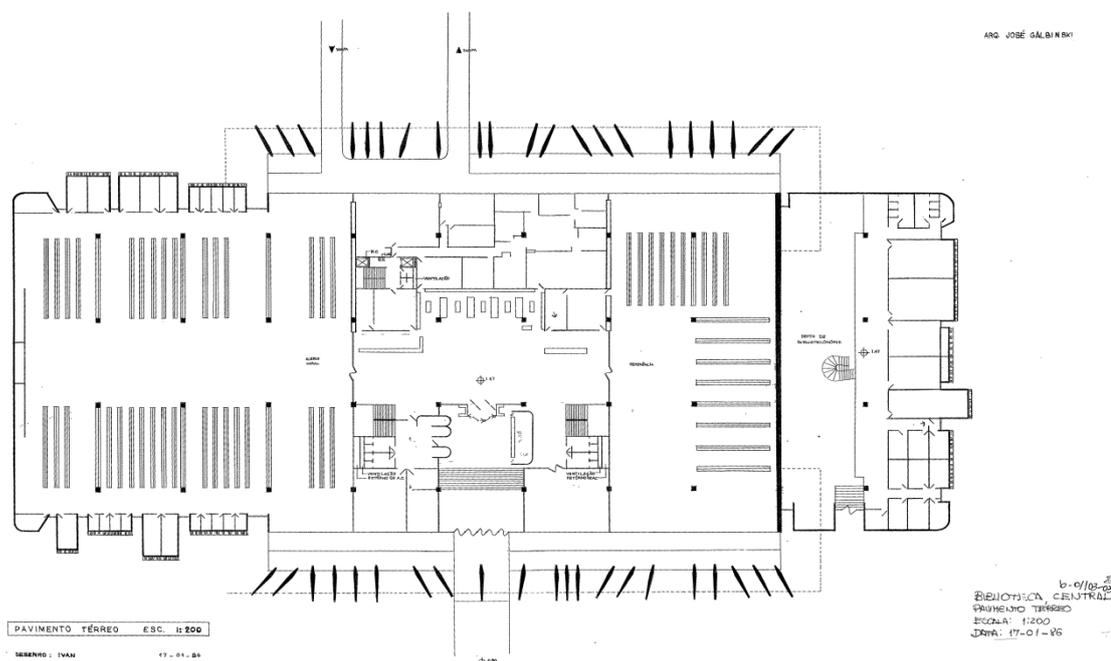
Planta baixa original do pavimento térreo da Biblioteca Central. José Galbinski, 17 de janeiro de 1986.
